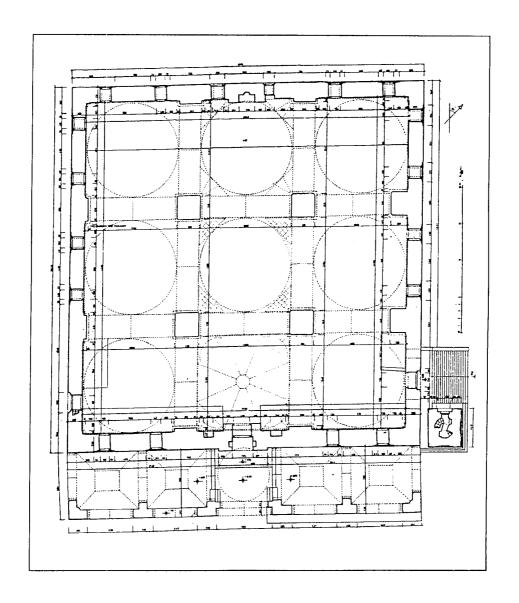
مسقط أفقي لمسجد روم محمد باشا في اسكدار باستانبول (عن : جودوين) .
